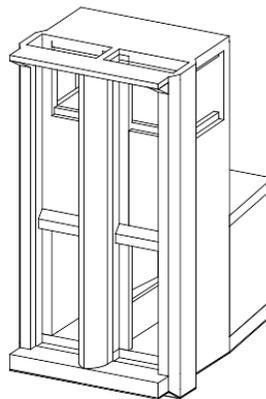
Plano Secciones del Túnel de Desvío.
